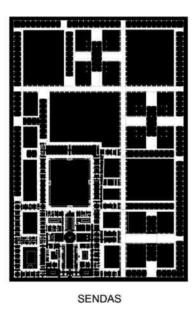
Planta primer nivel Sede Central Fundación Las Rosas, 2022. Fuente: Rodrigo Benavente, arquitecto Fundación Las Rosas.
